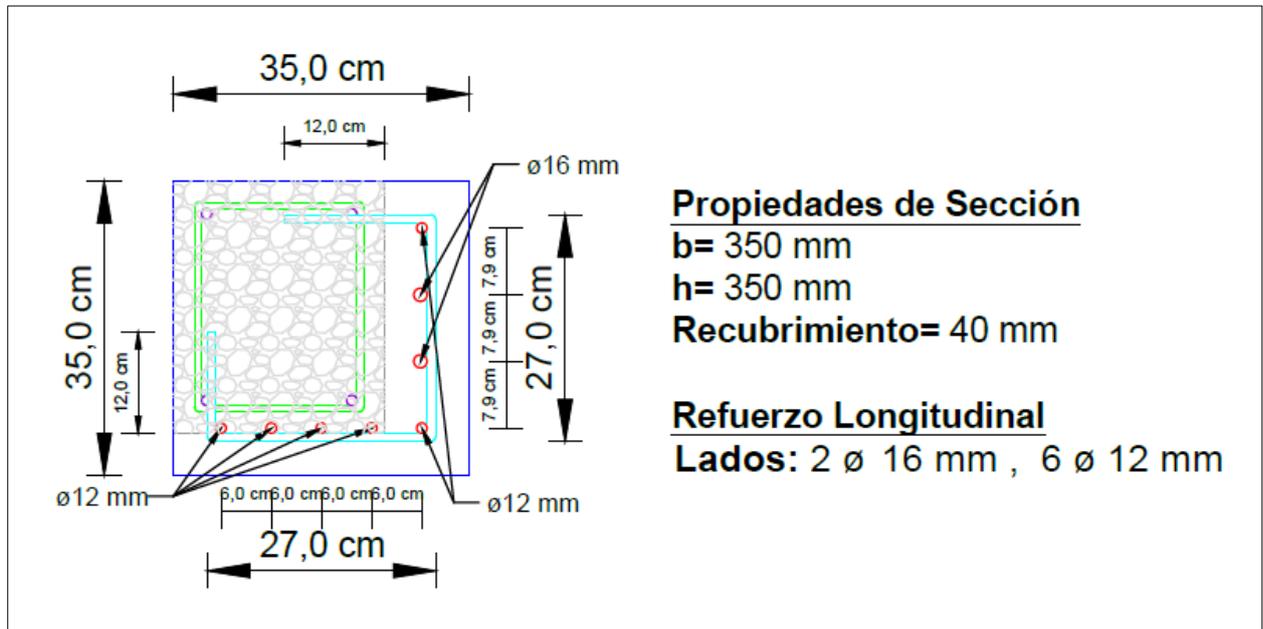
Columna Esquinera P3: Armado de encamisado.
